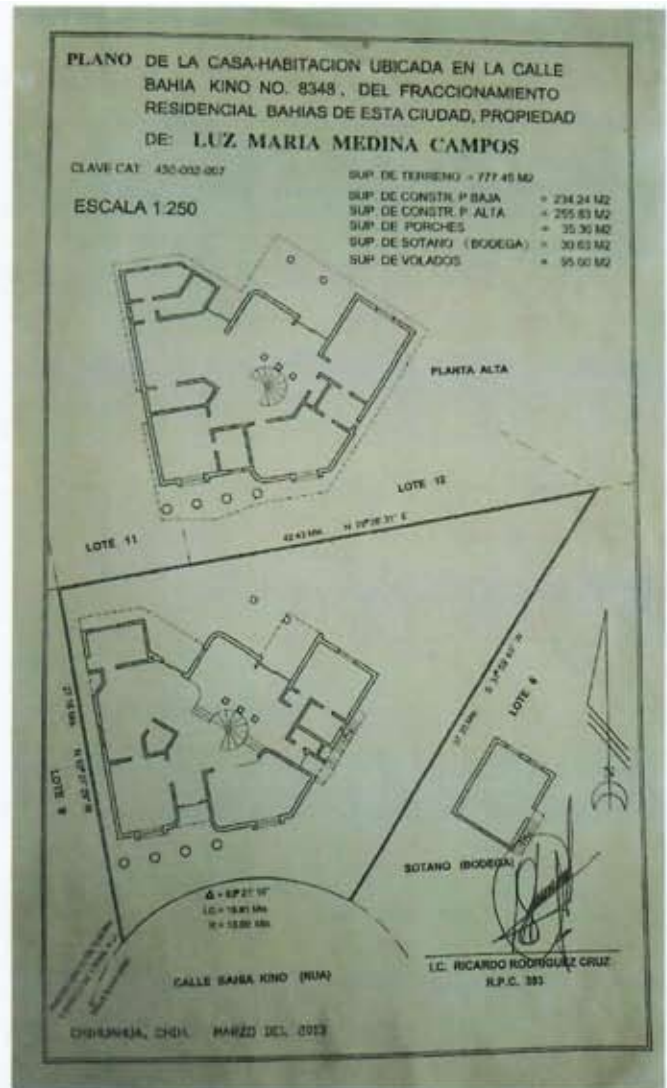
Plano catastral del Área de Aplicación.¹⁴
